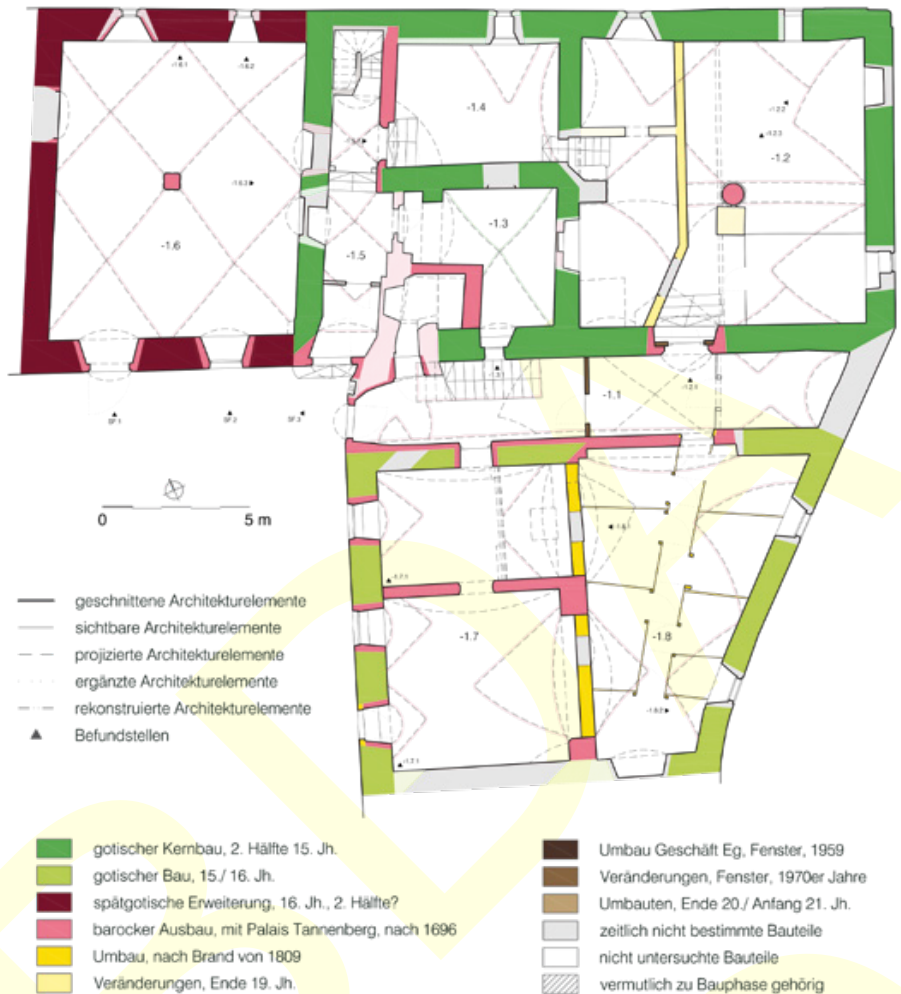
Schwaz, Bürgerhaus. Baualterplan des Kellergeschoßes.
